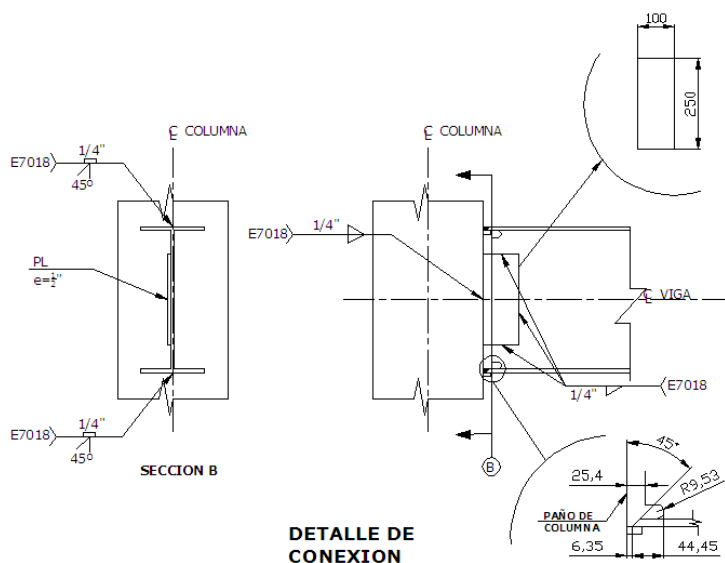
Especimen ECS1 de conexión soldada directamente
